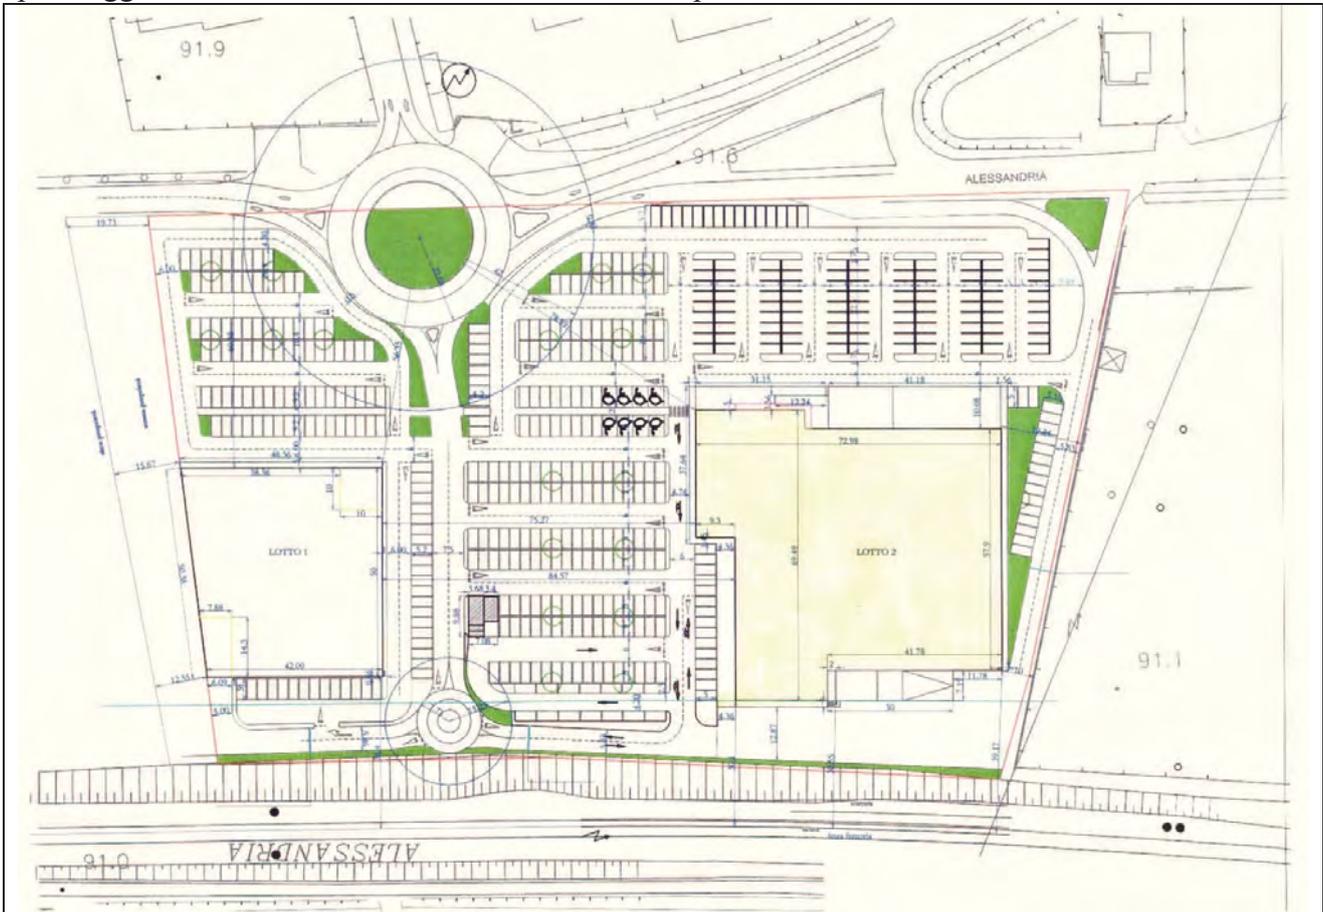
Vista planimetrica del progetto: fabbricati commerciali Lotto 1 e Lotto 2, parcheggio e rotatoria.
